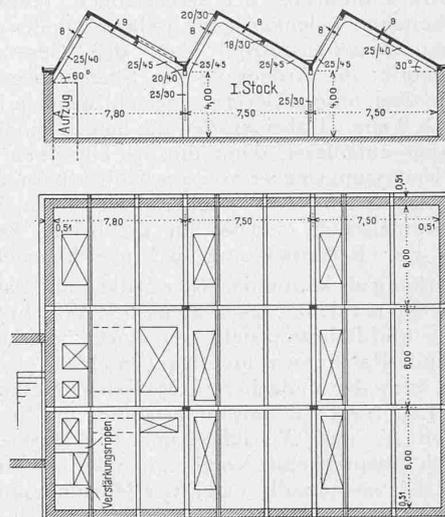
Grundriss und Querschnitt. — Masstab 1 : 400.
